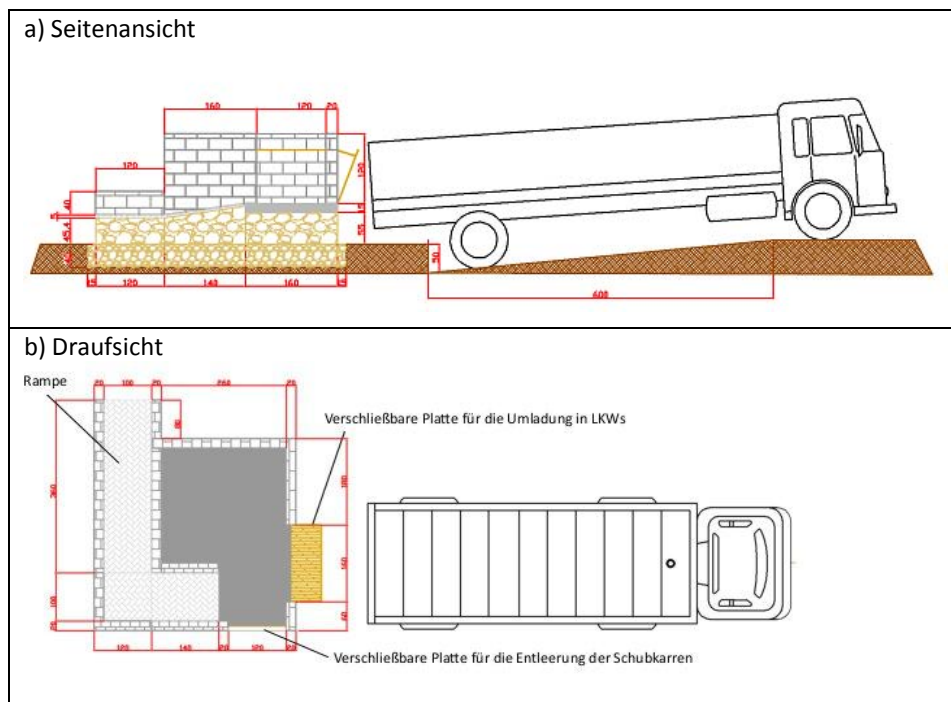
a) Seiten- und b) Draufsicht der Umladestation mit Rampe in Hargeysa (nach BELLA, 2010)
